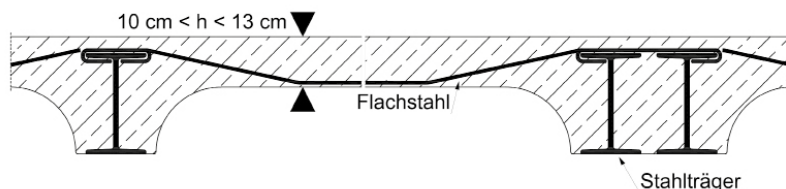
Längsschnitt einer Stahlbetondecke mit auflagnernah aufgebogener Bewehrung (Koenen'sche Voutendecke)
